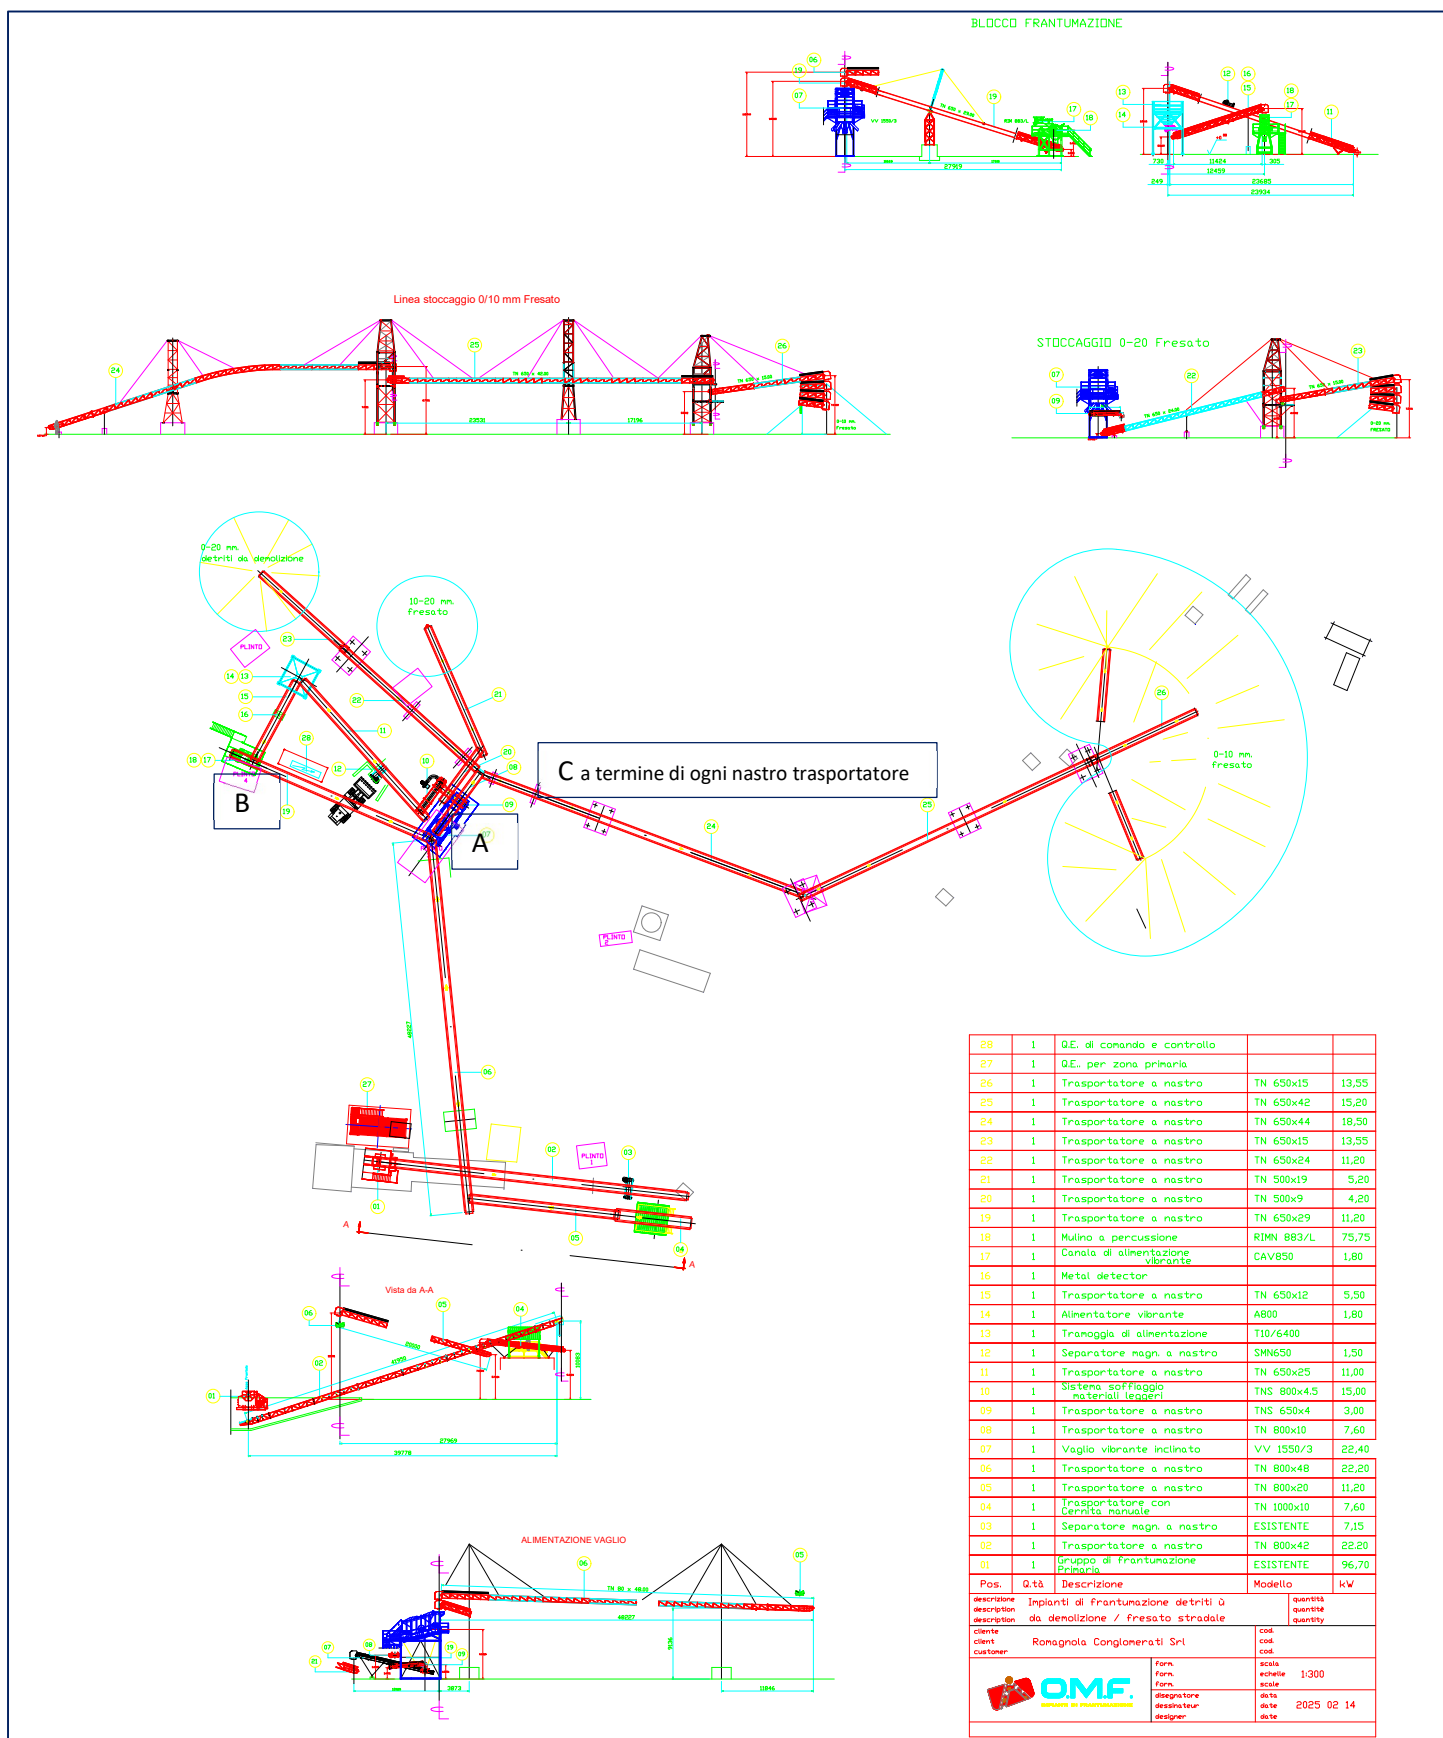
prospetti e planimetria nuovo frantumatore di progetto.
